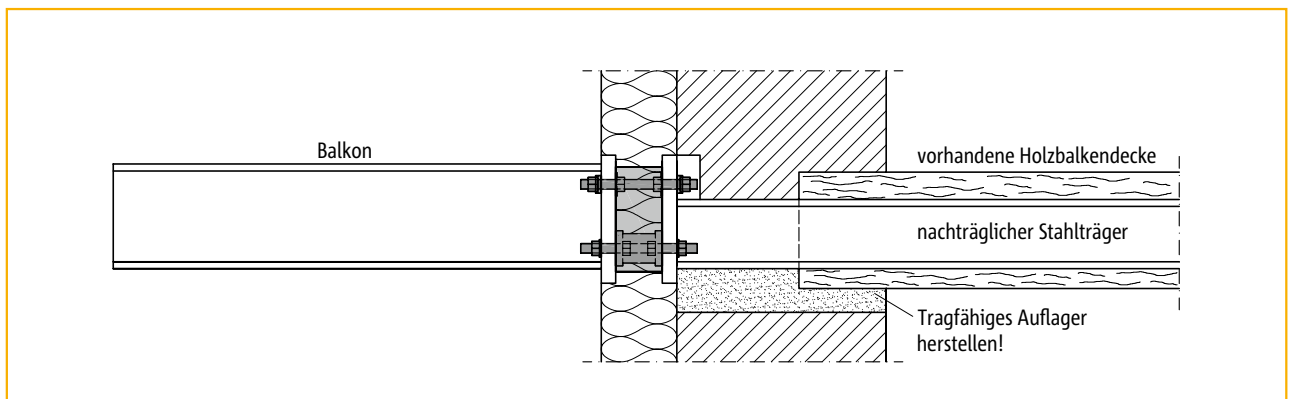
Balkon frei auskragend, angeschlossen mit Typ KST angeschlossen an Holzbalkendecke (Stahlbalkon)
